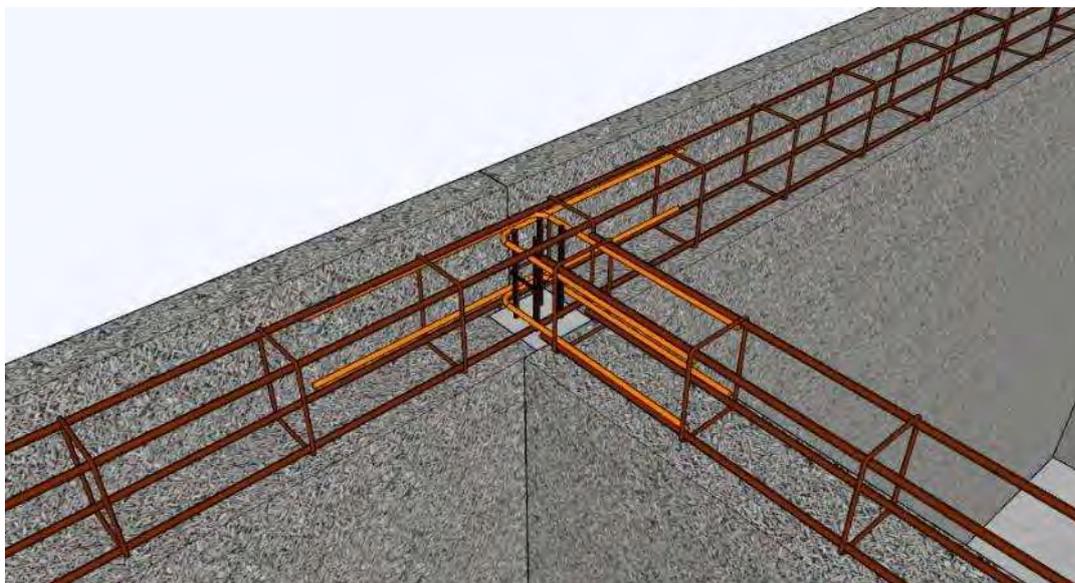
Longueur minimum de retour d'angle en panneau CS2
